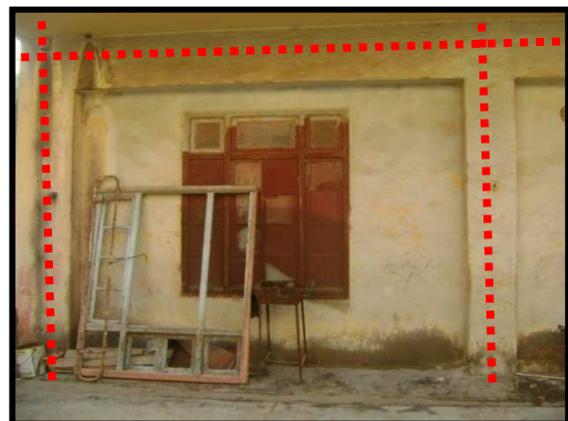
Photo du système poteaux-poutre de l'extension, source : l'auteur.
